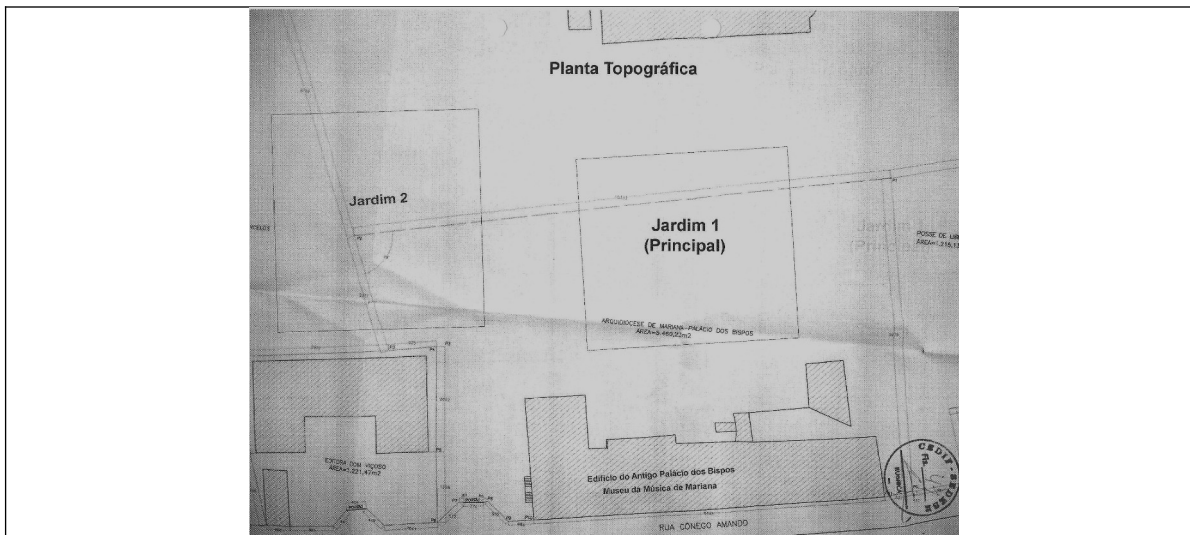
Acima Planta das áreas contempladas pelo projeto apresentado pela FUNDARQ.
